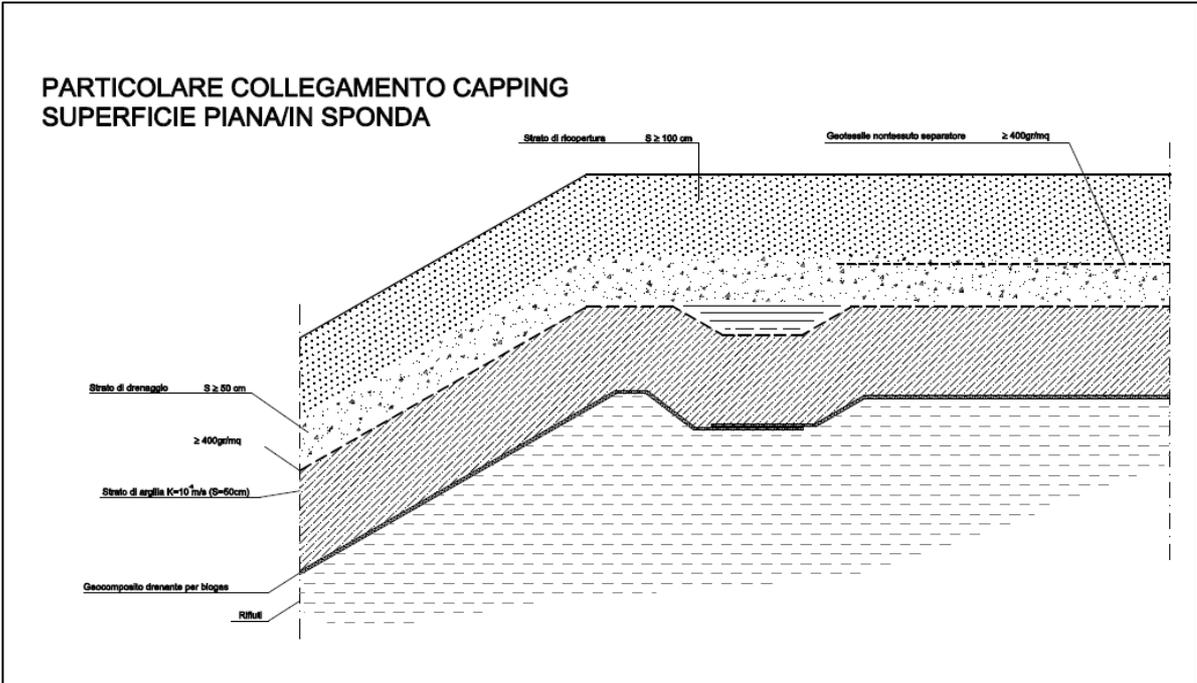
Pacchetto chiusura finale della discarica (particolare)
